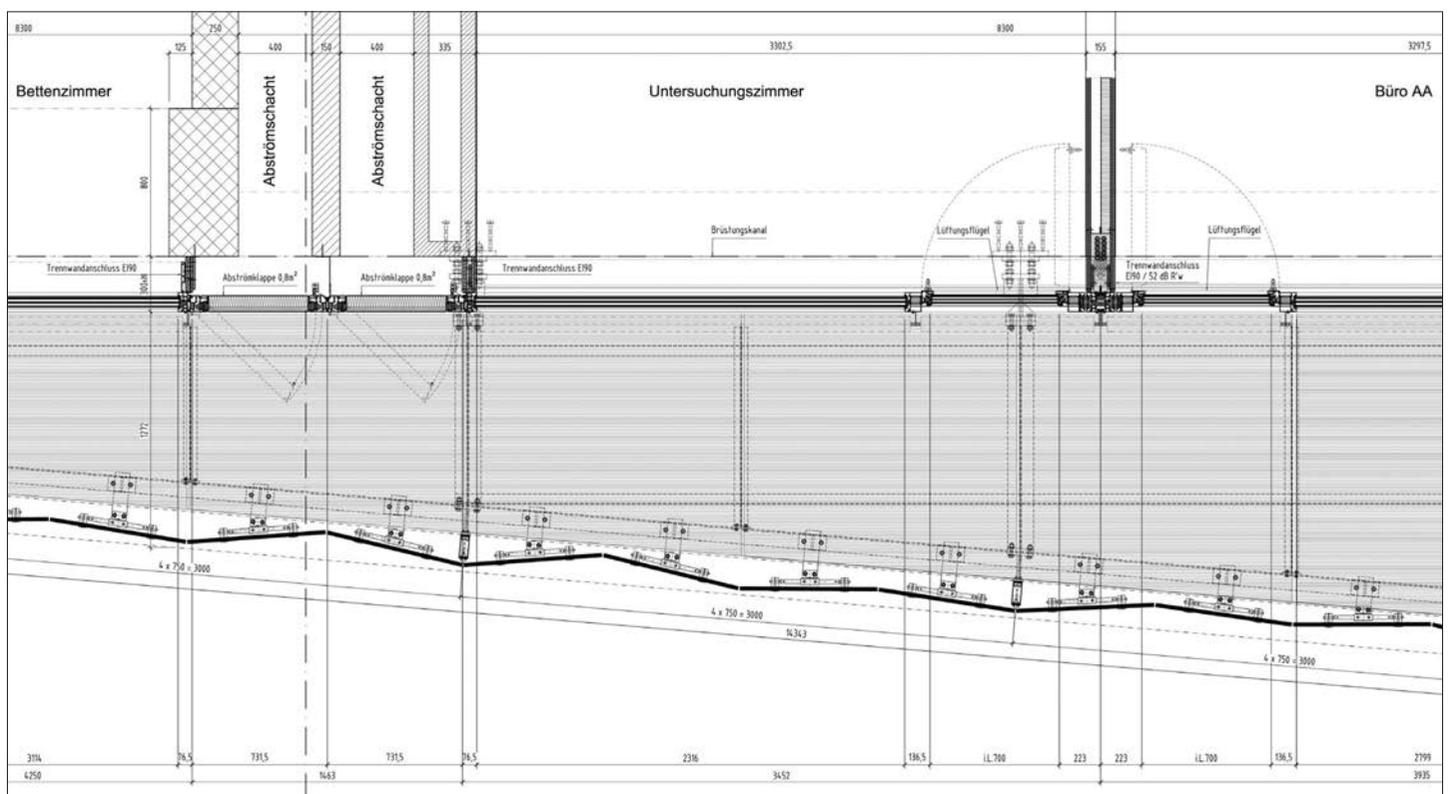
Horizontalschnitt: Fenster Büro, RDA-Klappen und Brüstung Serviceschicht.
